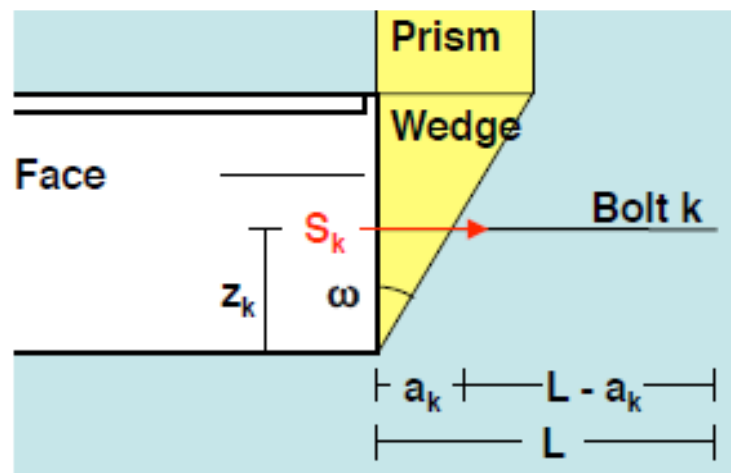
Schema di calcolo della forza applicata dall'elemento al fronte
